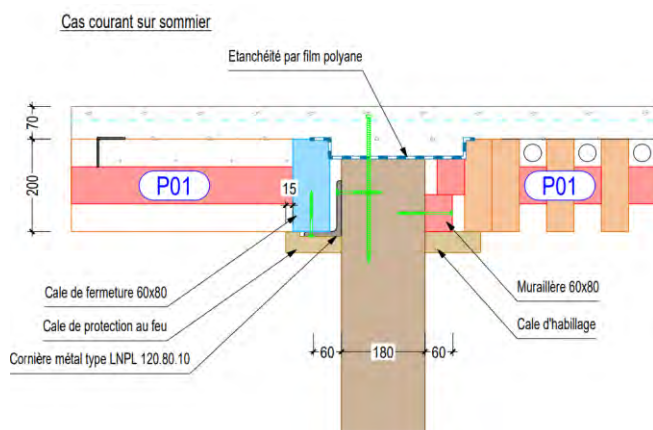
Coupe type d'appui de planchers D-dalle sur poutre
